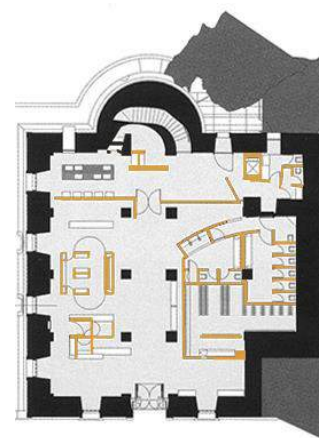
Planta do Piso 0 onde se distingue a intervenção (Amarelo) e a estrutura pré-existente (Preto)
